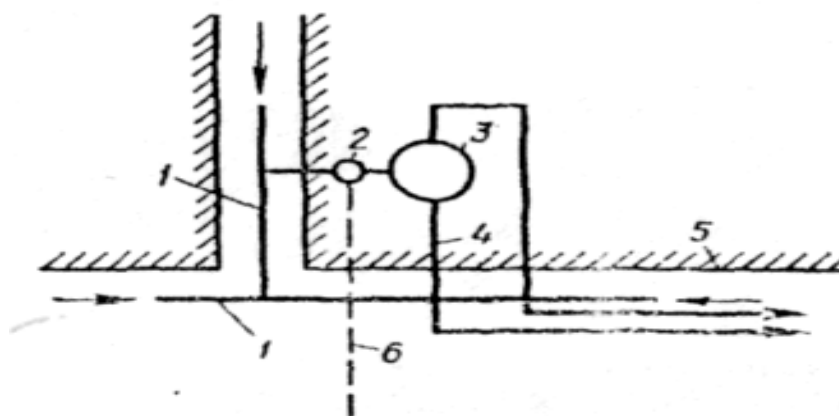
Схема расположения насосной станции и трубопроводов:
